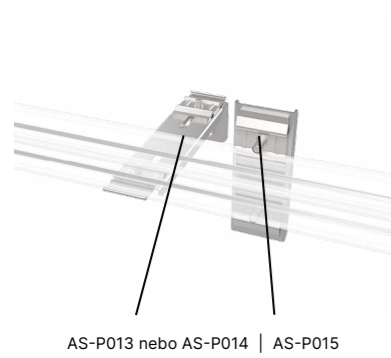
Částečně vysoká konstrukce před zdí a jednou boční nosnou zdí
